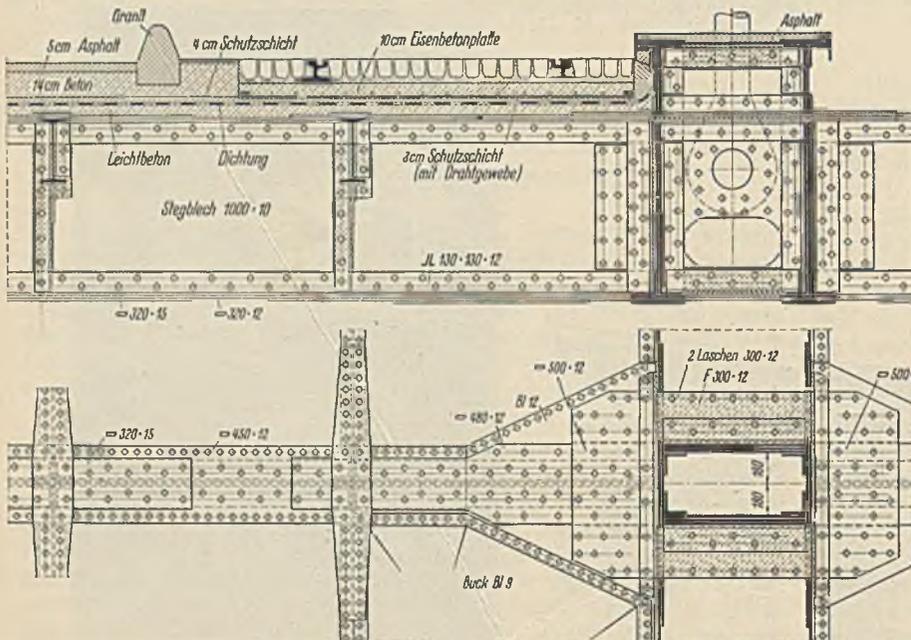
Durchführung des Hauptquerträgers durch den Hauptlängsträger und Schnitt durch die Fahrabdeckung.
